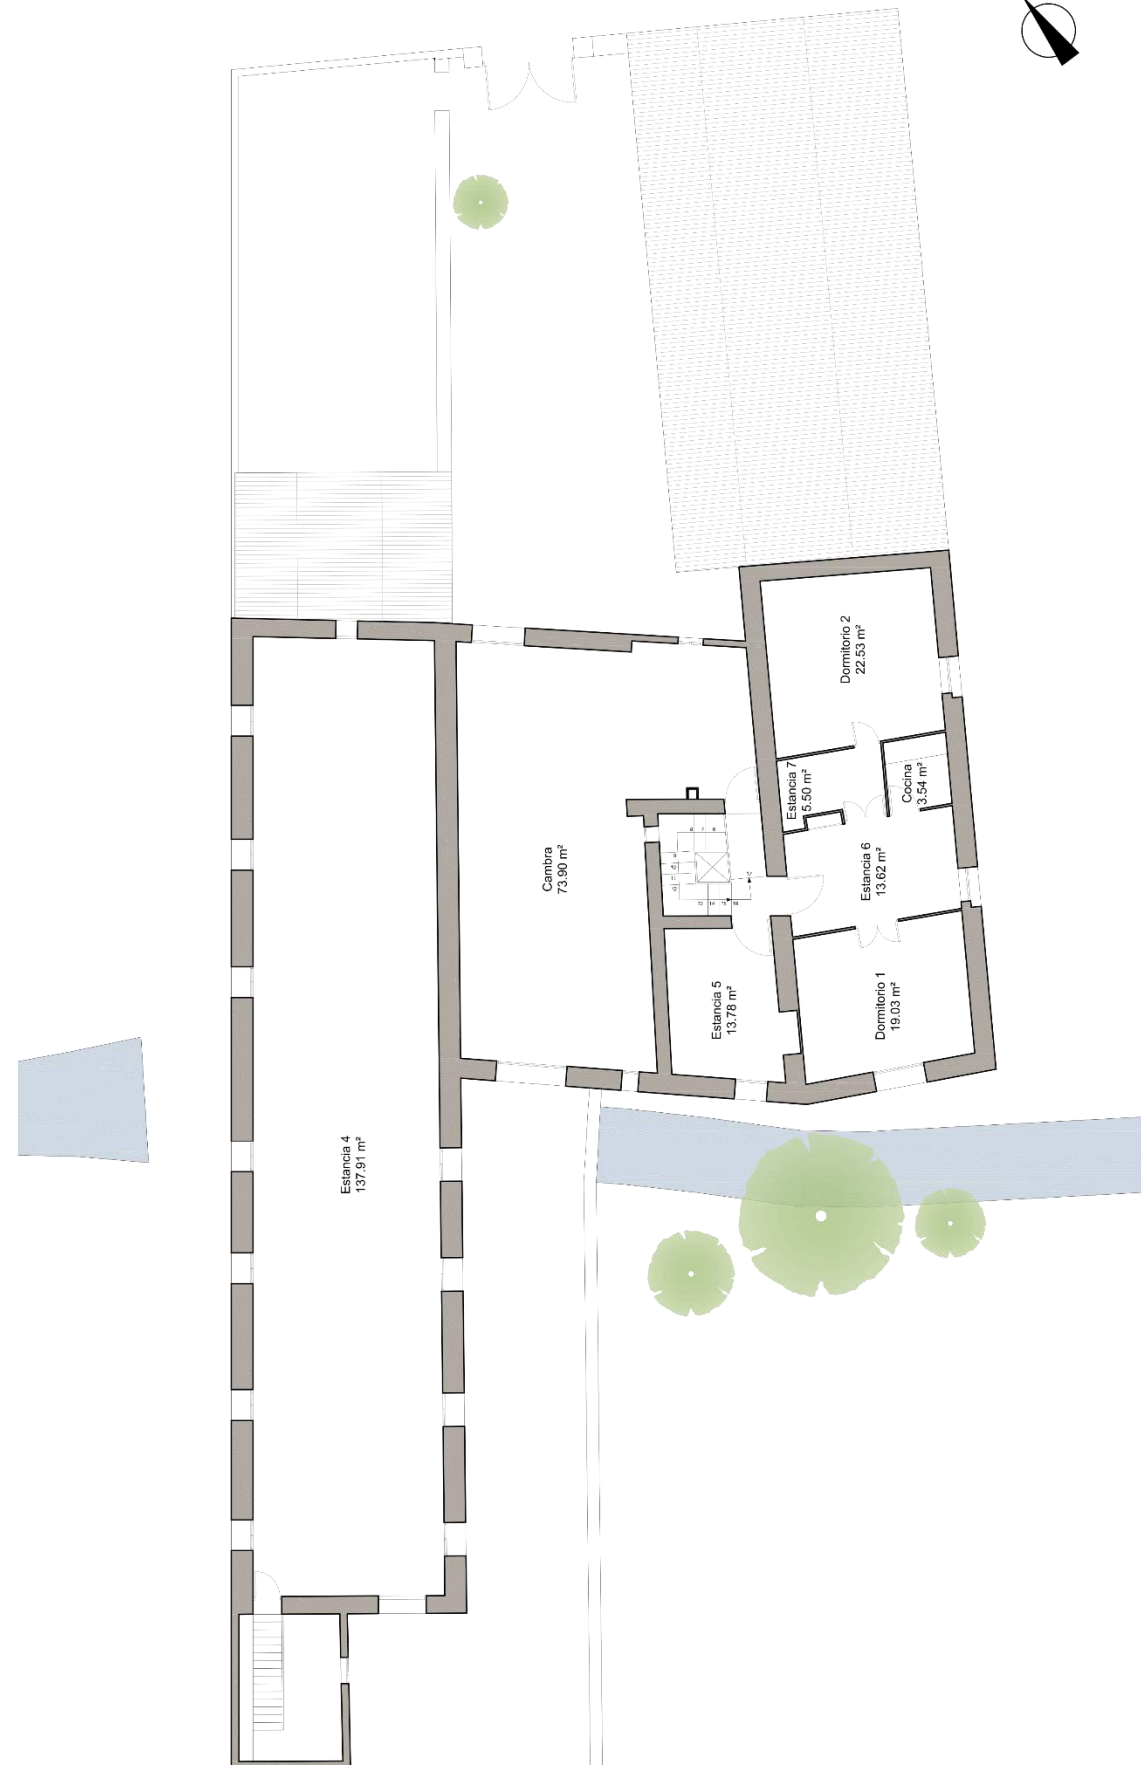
Plano de Planta Primera. Alquería de Farinós. 2015.
